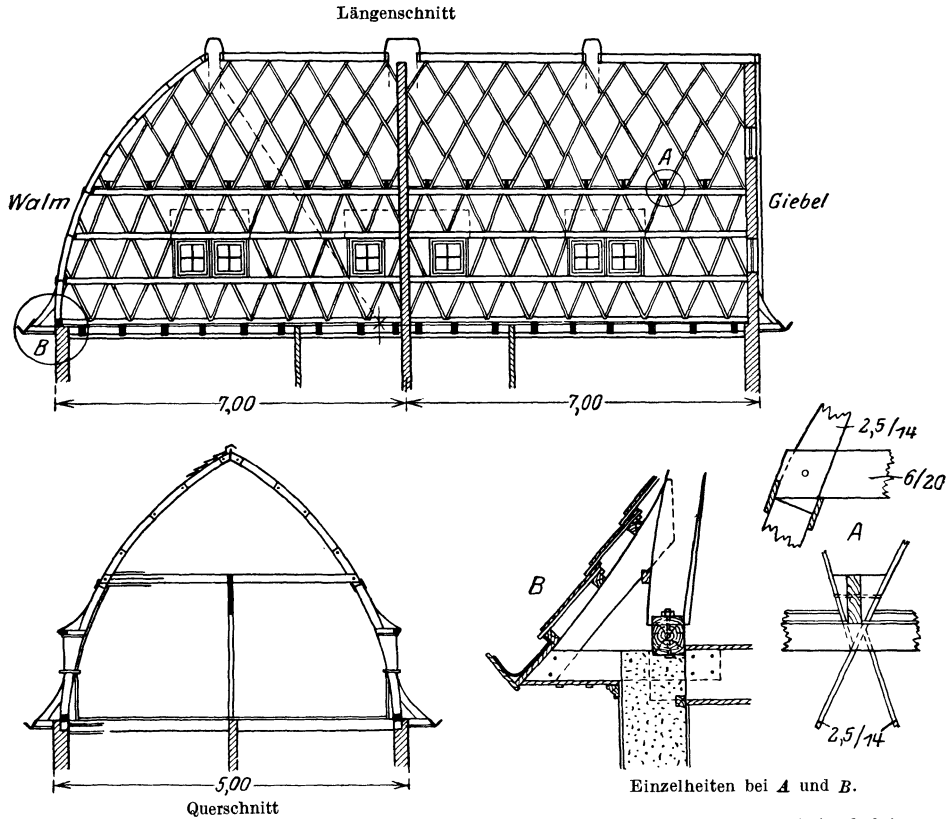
Dach eines Einfamilienhauses nach dem Zollbau-System (mit eingebauter Zwischendecke).
